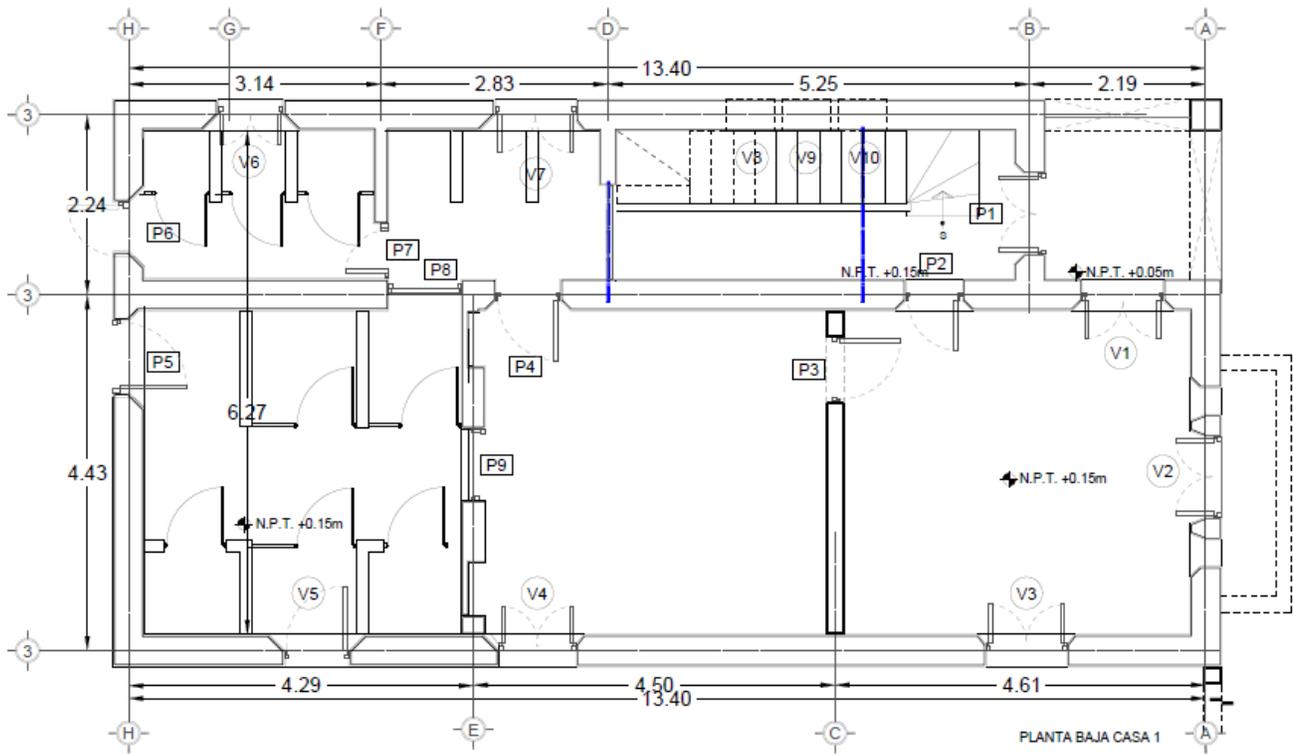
Plano localización de puertas y ventanas Planta Baja
